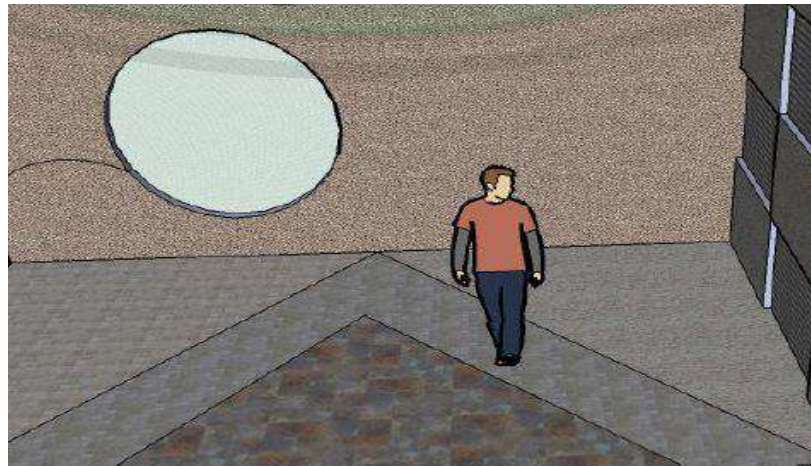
Langit-langit sebagai unsur pembentuk ruang
